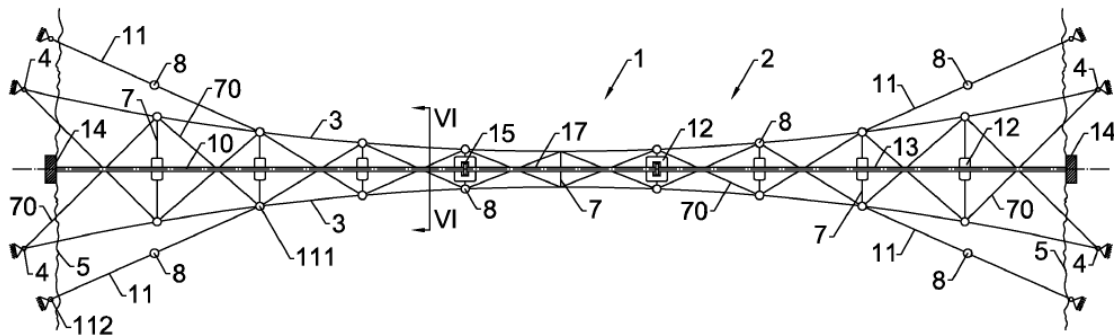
Grundriss, Variante 1b (Kollegger, et al., 2015)
